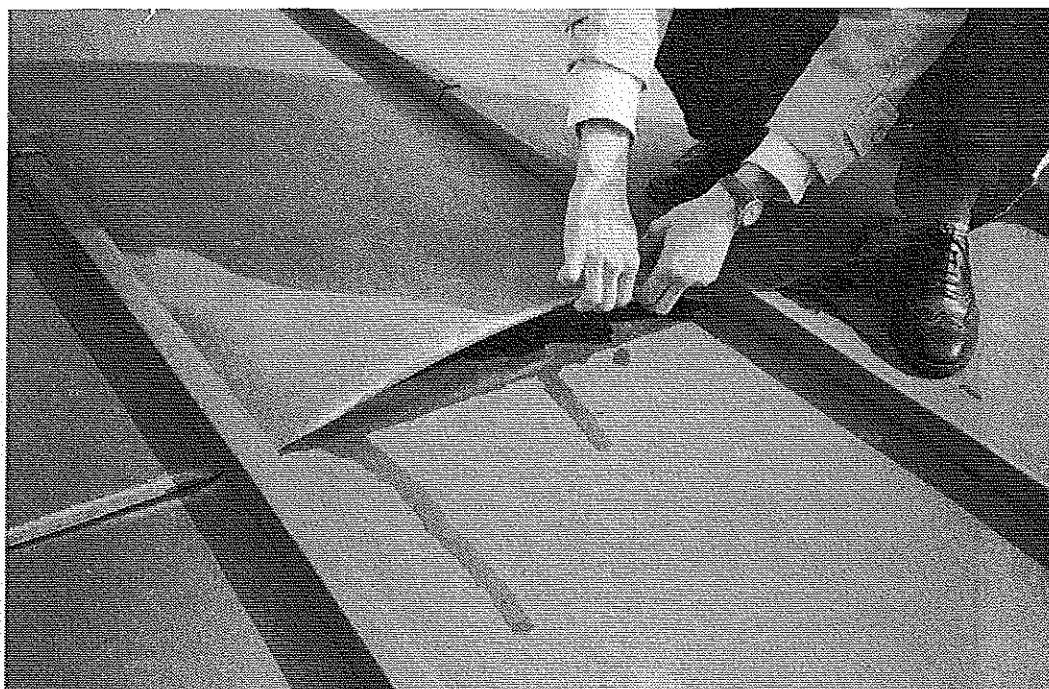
Défaut d'étanchéité des zones de recouvrement. Simple recouvrement sans agrafure. Remontées capillaires dans la zone de recouvrement. © J. Putatti
